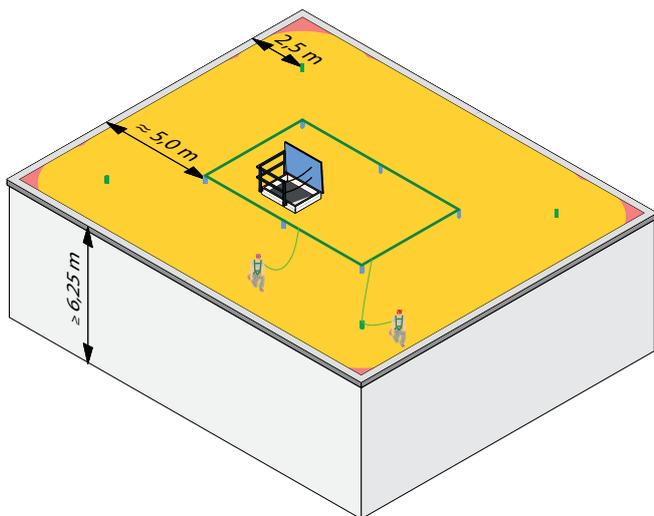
Ausstattungsklasse 2: Ein Sturzauffangsystem kombiniert mit EAP in den Ecken
